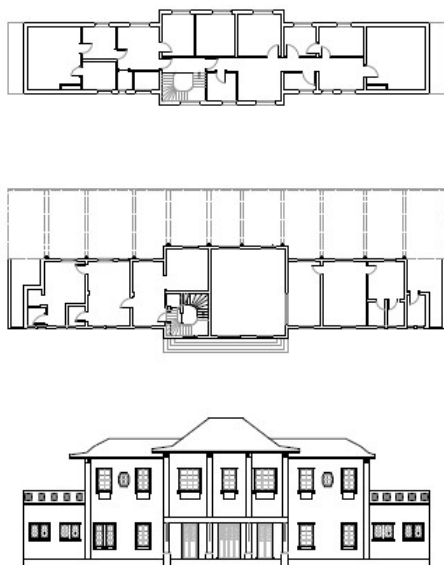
Plantas Baixas e Fachada da Estação Ferroviária de Alegrete.
